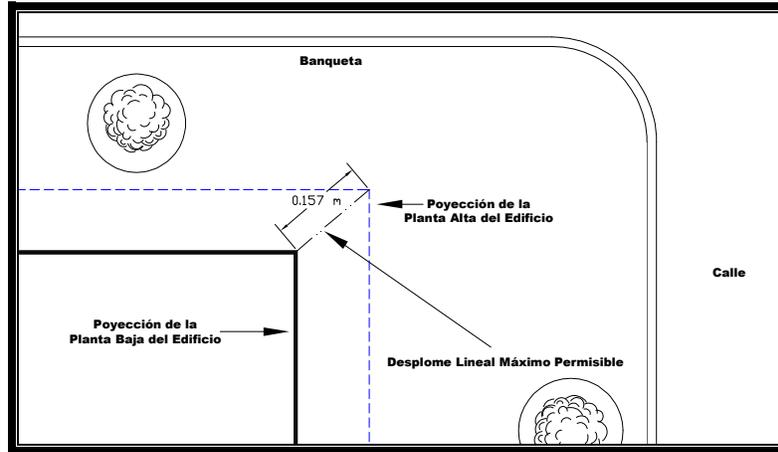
Desplome lineal máximo permisible para un inmueble de 30 metros. Vista Planta.
